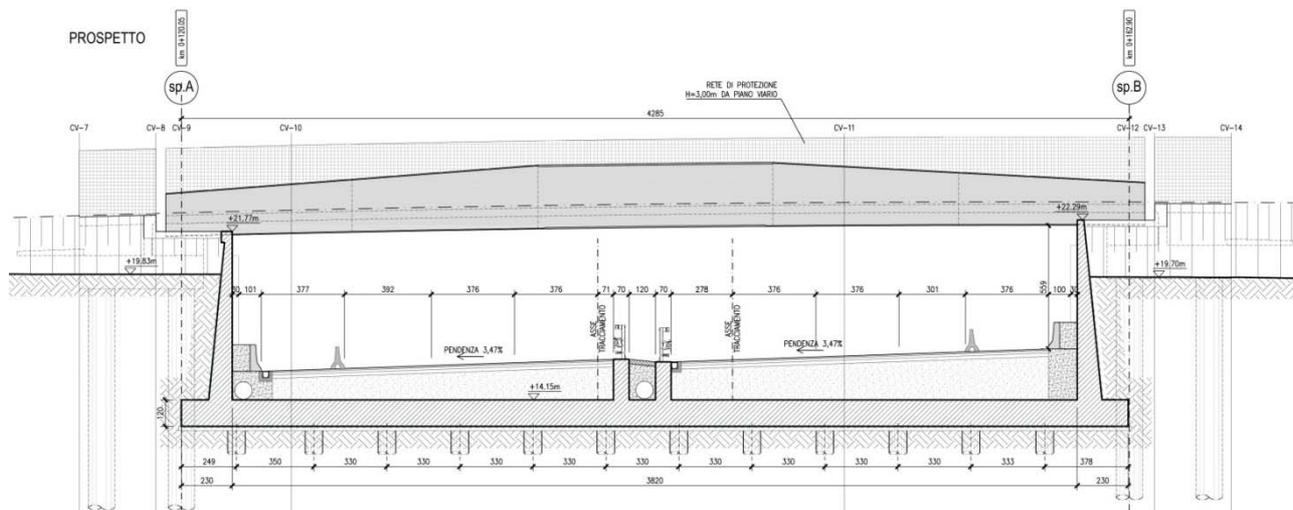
PROSPETTO IMPALCATO
